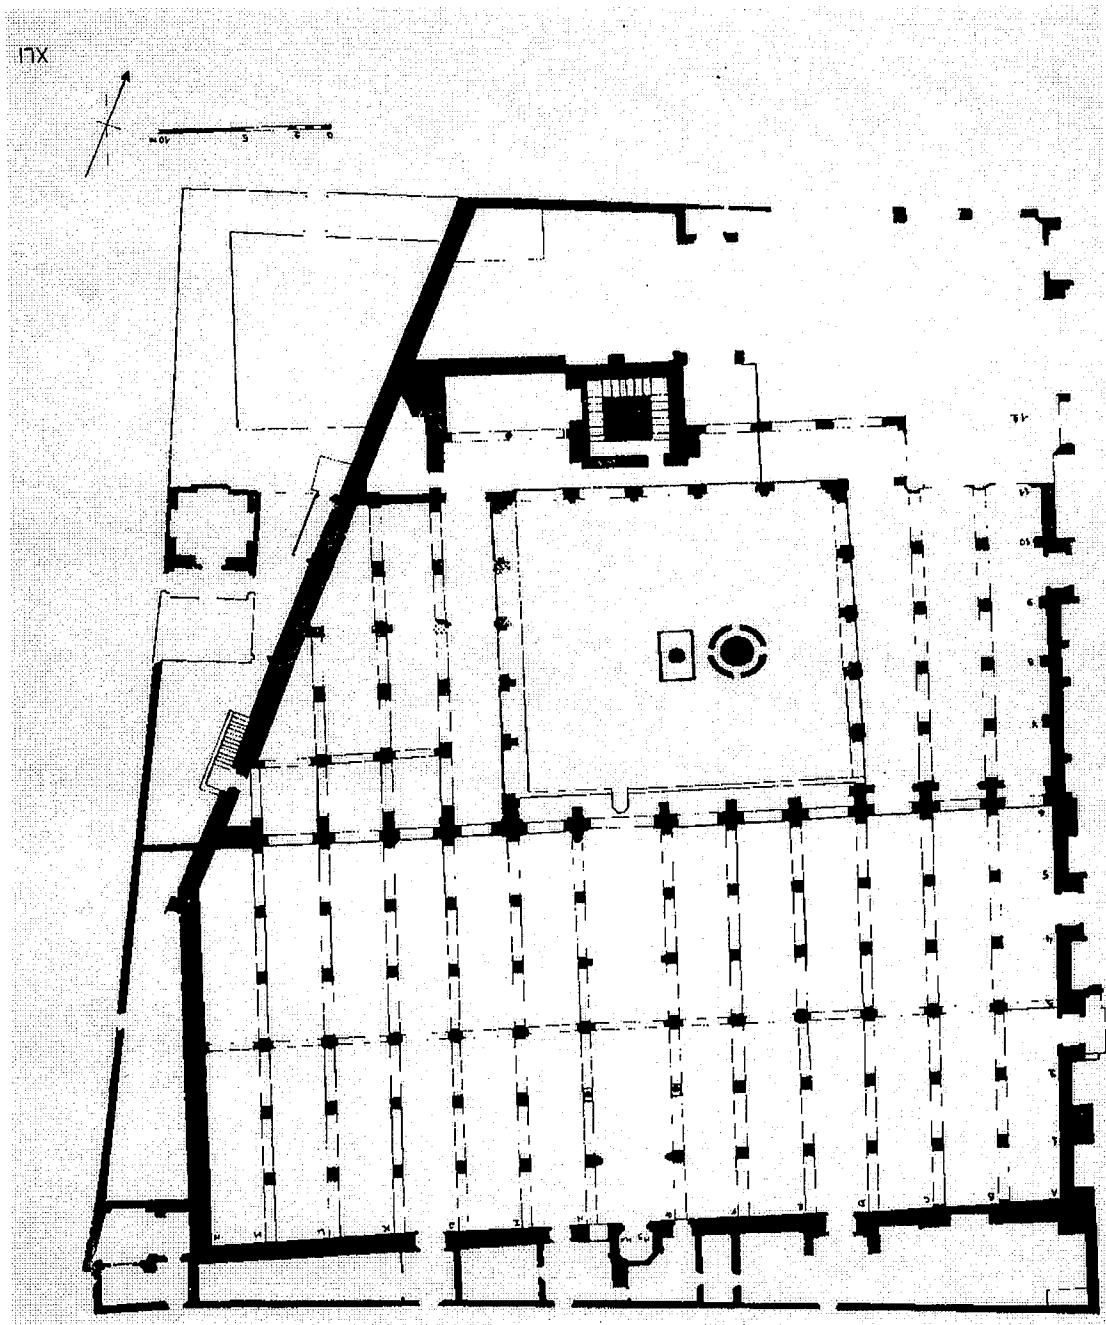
مخطط أفقي لضريح السنوسي
